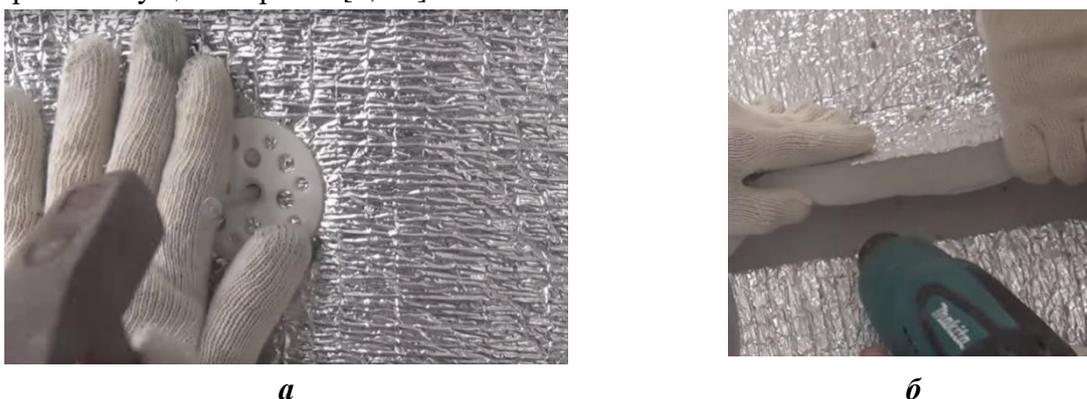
Монтаж теплоизоляции: а – механическое закрепление листа утеплителя; б – сварка стыков рулонного пенополиэтилена
